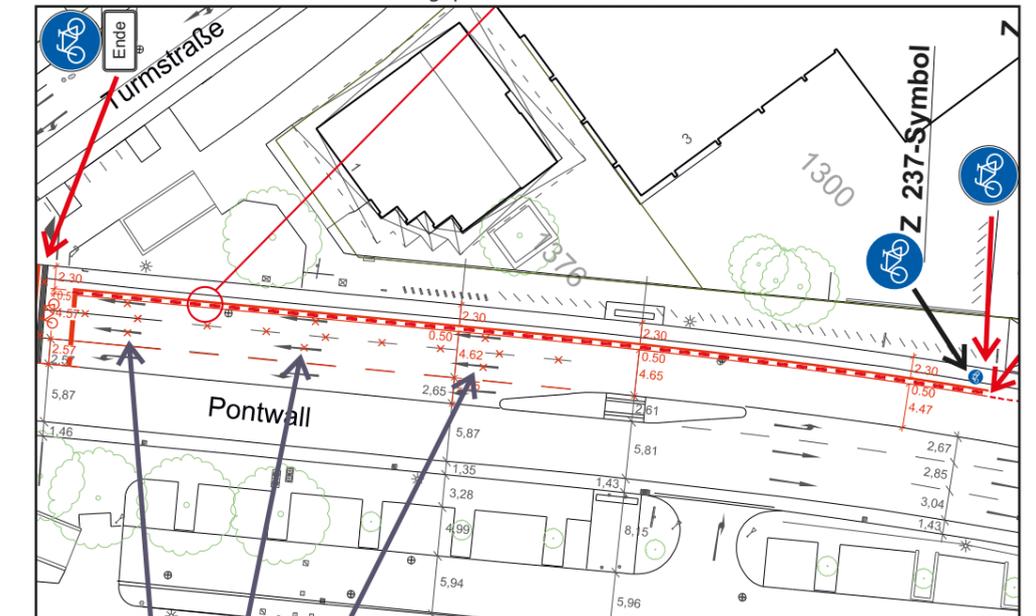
Verortung Verkehrsversuch Pontwall Abb. 23: Verkehrsversuch Pontwall Abb. 24: Lageplan Verkehrsversuch Pontwall
